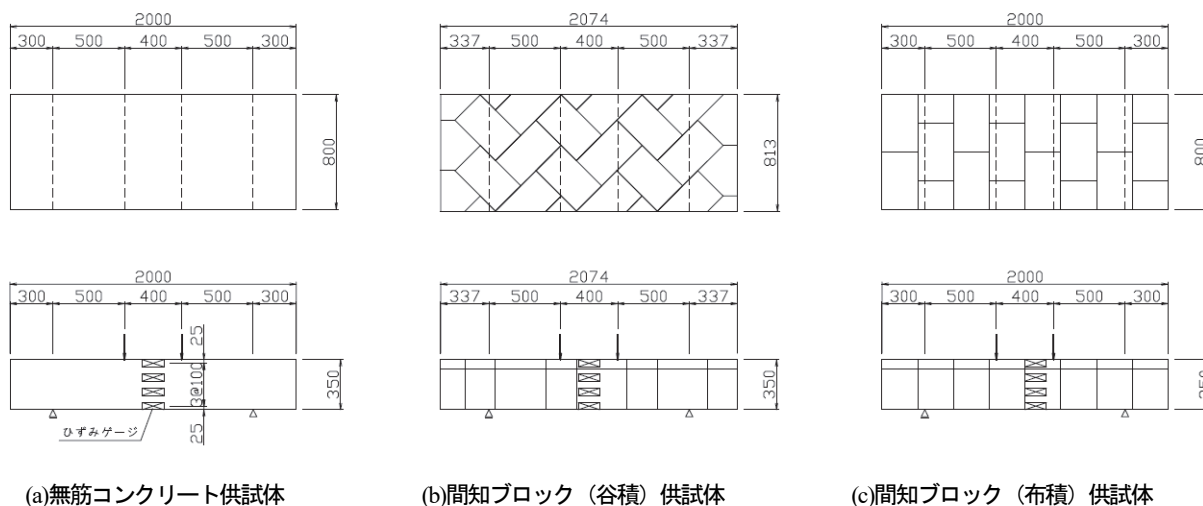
供試体 (上段:平面図、下段:側面図) (単位:mm)
